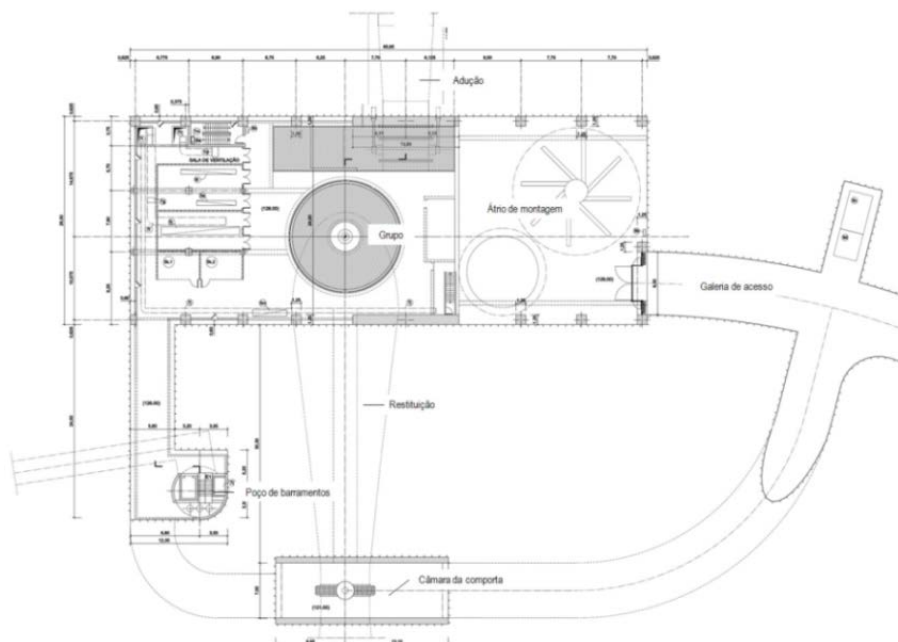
Planta do Piso Principal da Central, (EDP, 2010).
